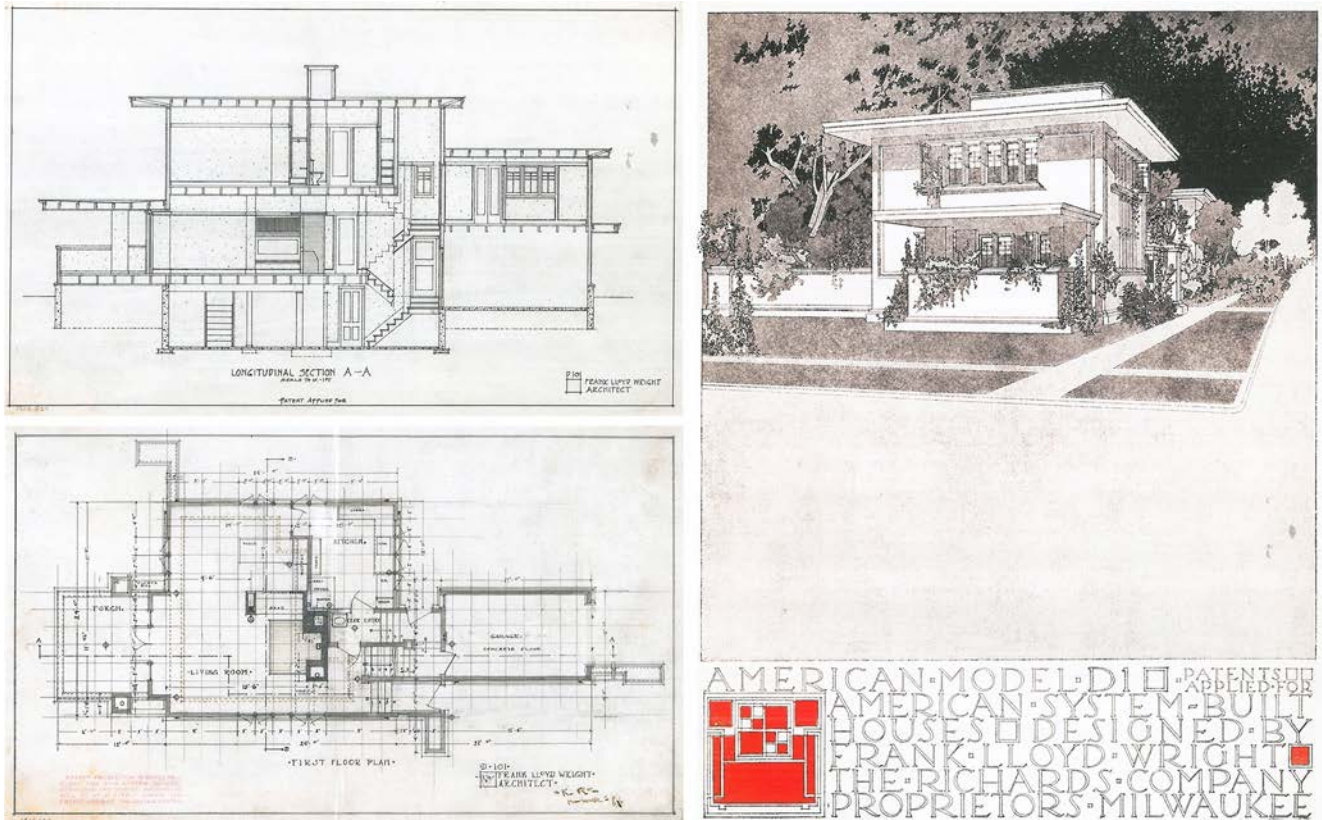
American System-Built Houses. Modelo D10. Planta baja, sección y ficha del catálogo (The Frank Lloyd Wright Foundation).
